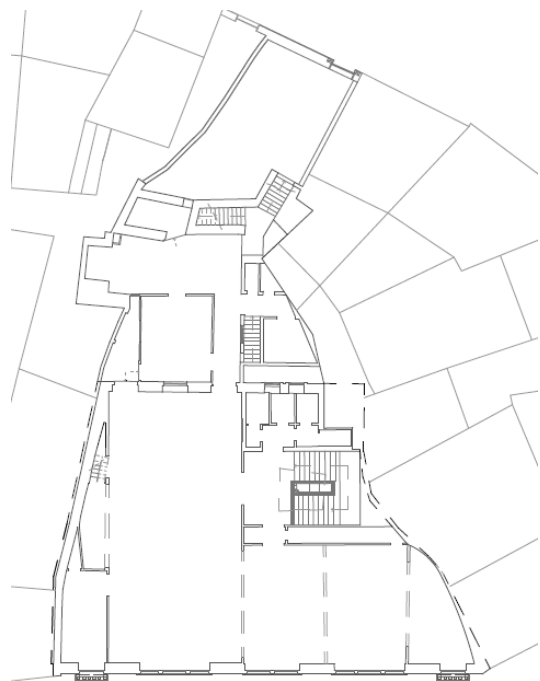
Levantamento da planta do piso 1 do edifício em estudo
